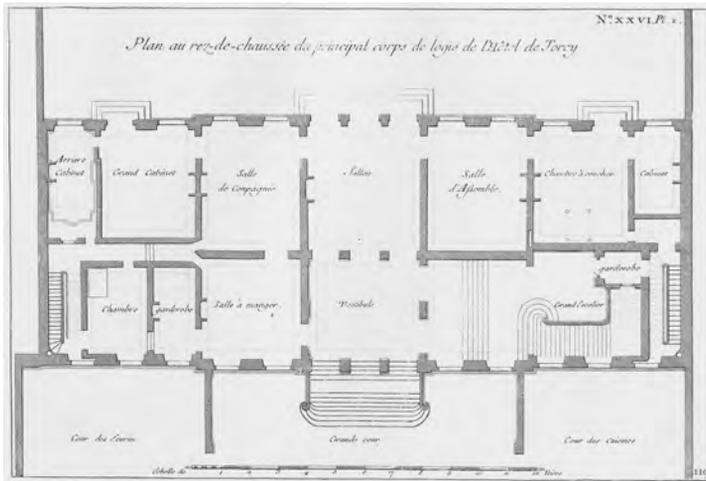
Paris, Hôtel de Torcy, Grundriss, Erdgeschoss
